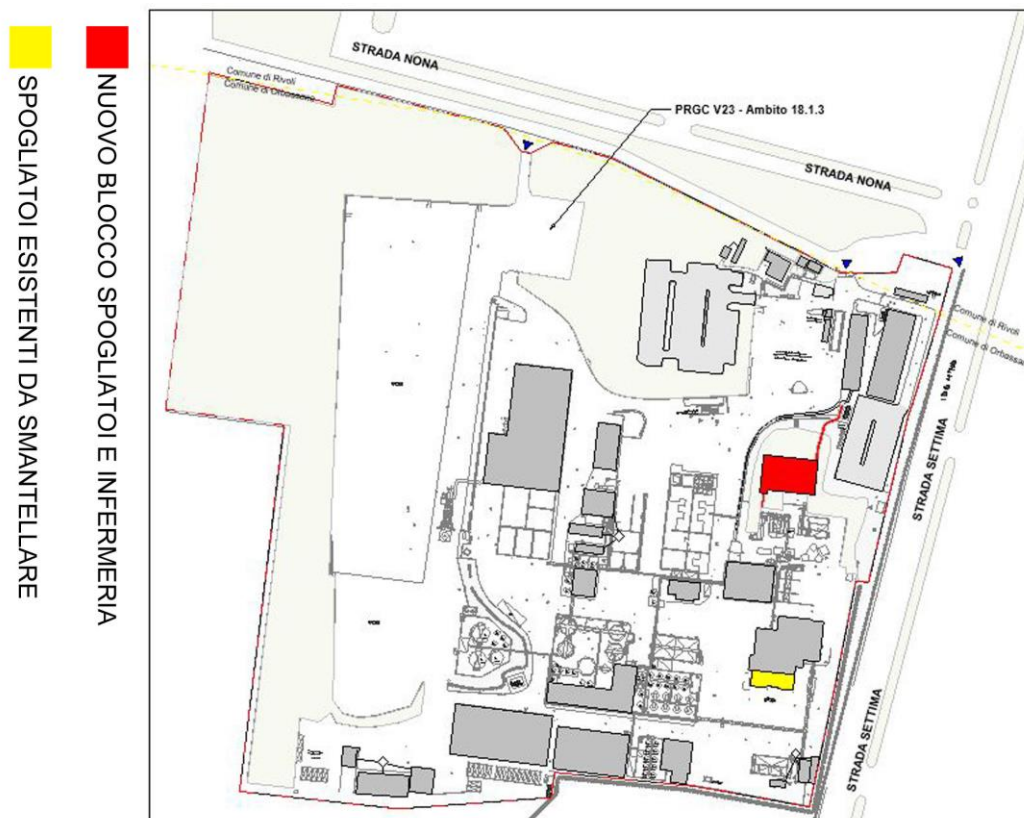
Planimetria generale dell'impianto con ubicazione spogliatoi
